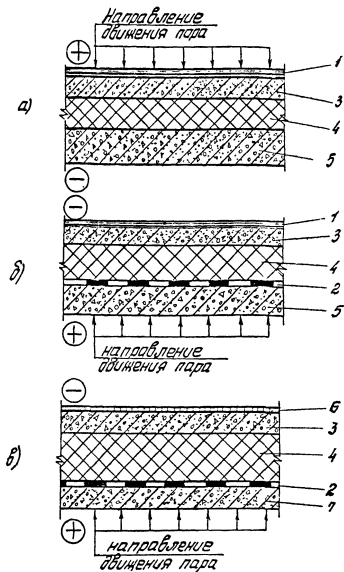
Схемы тепло и парозащиты покрытий и перекрытий над подпольем.
